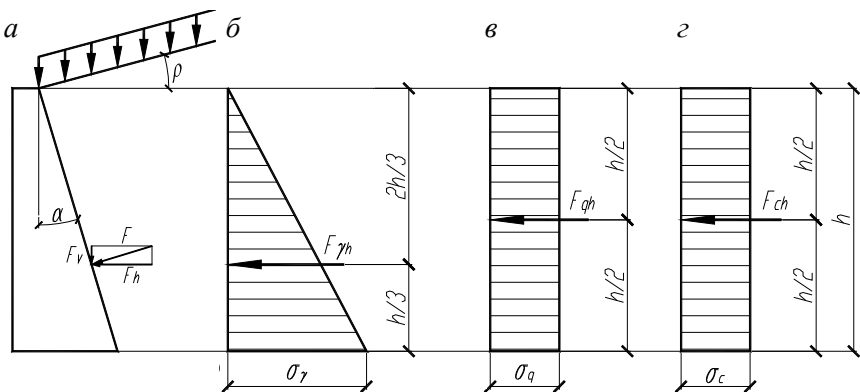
Схема к определению давления грунта на подпорную стенку
